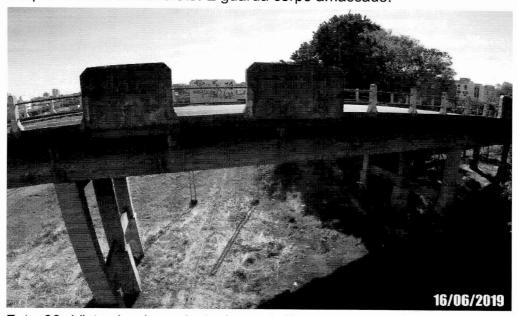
Vista da viga principal com infiltração na junta, eflorescência e desplacamento de concreto no apoio do guarda corpo.
